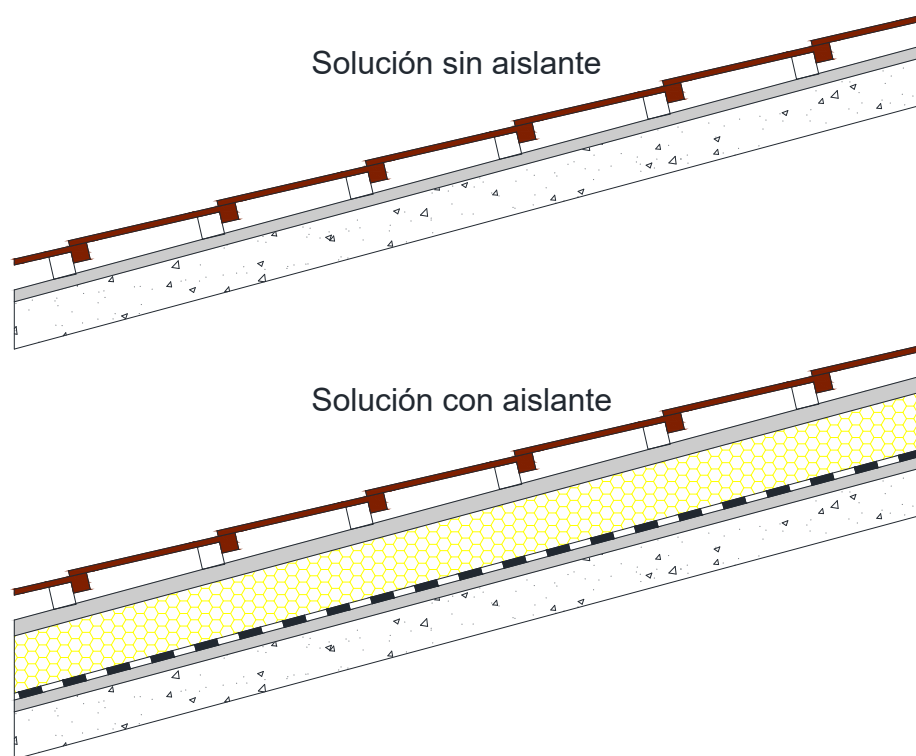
Ejemplo de actuación en cubierta inclinada tipo
